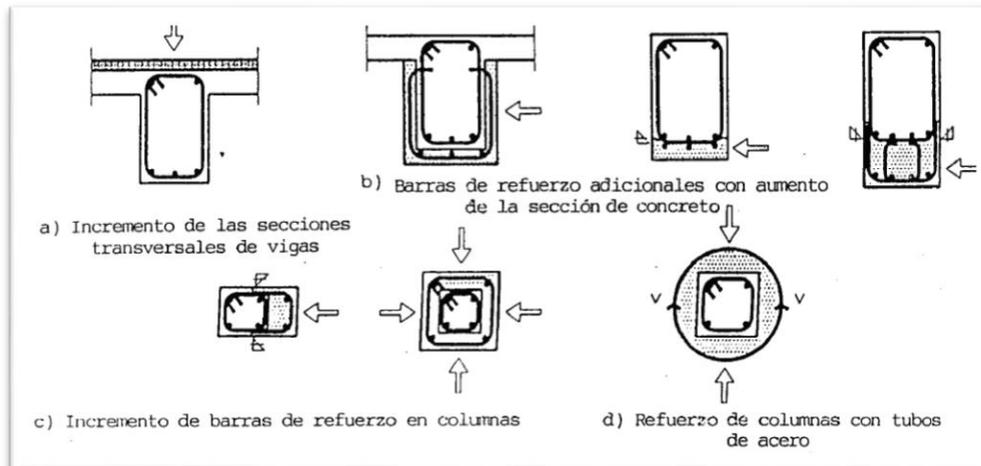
Incremento de la sección transversal, reforzamiento de columnas.
